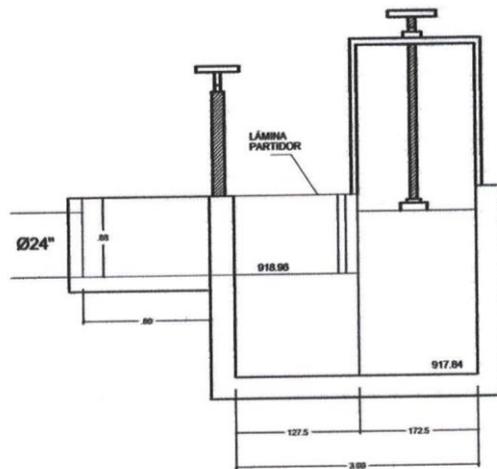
Detalle de la obra de captación, vistas en corte transversal.
